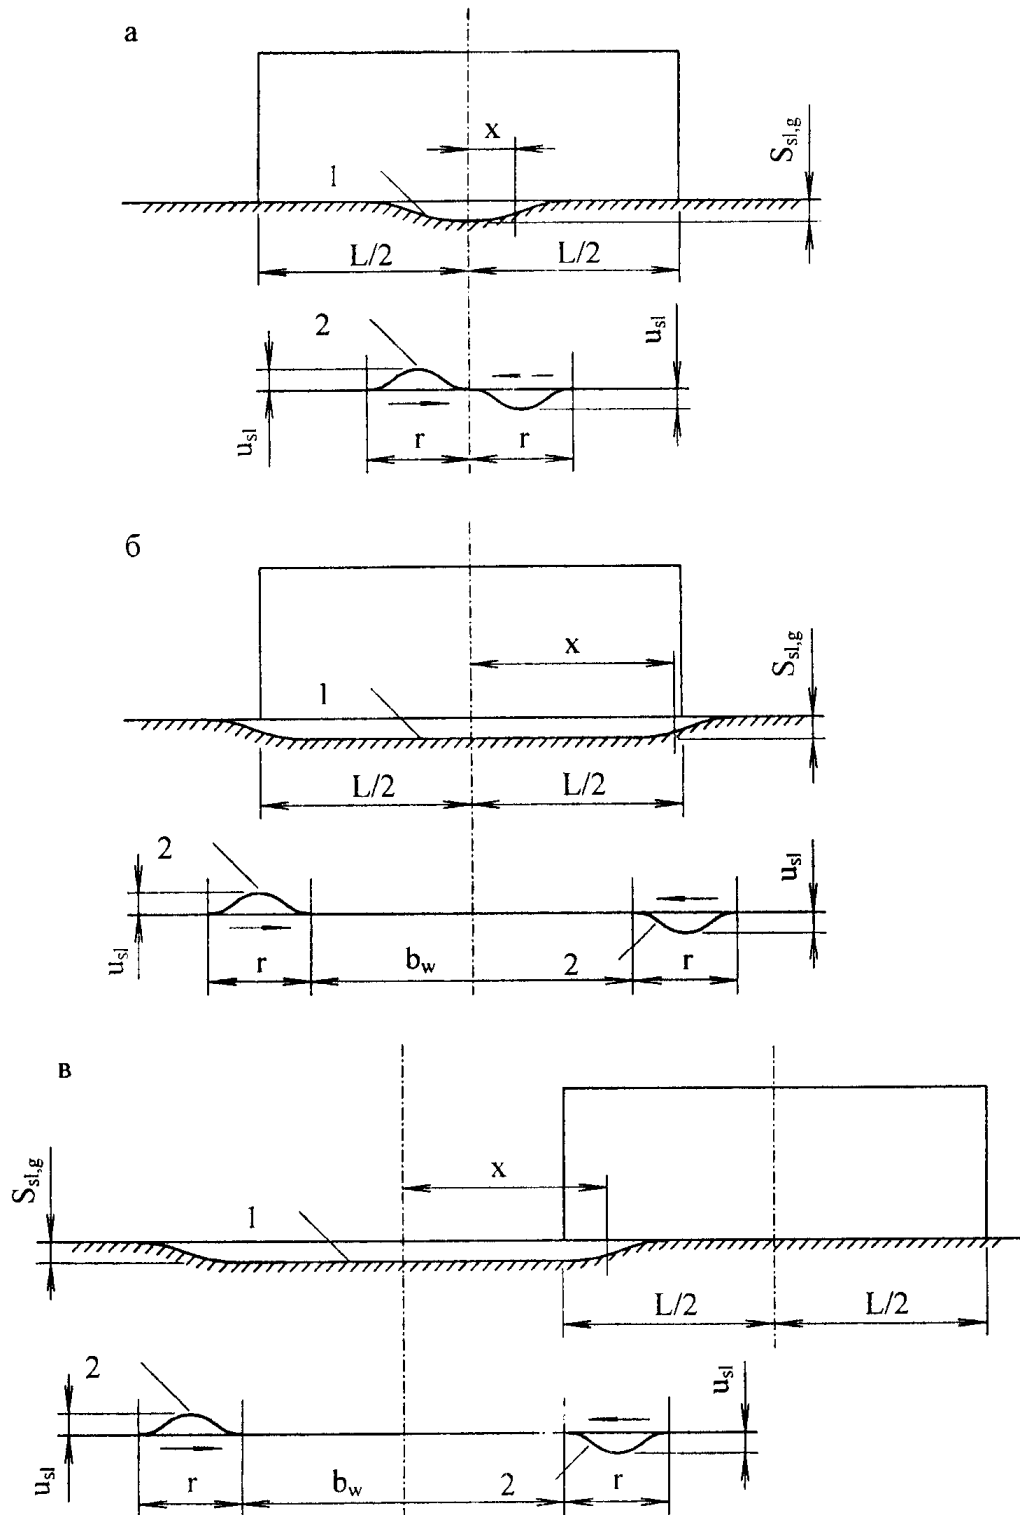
Схеми до розрахунку основи типу А (стовпчасті та стрічкові фундаменти)
